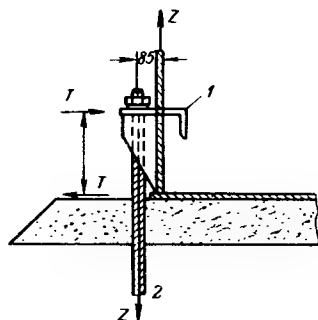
Расчетная схема низа анкера и железобетонной плиты
